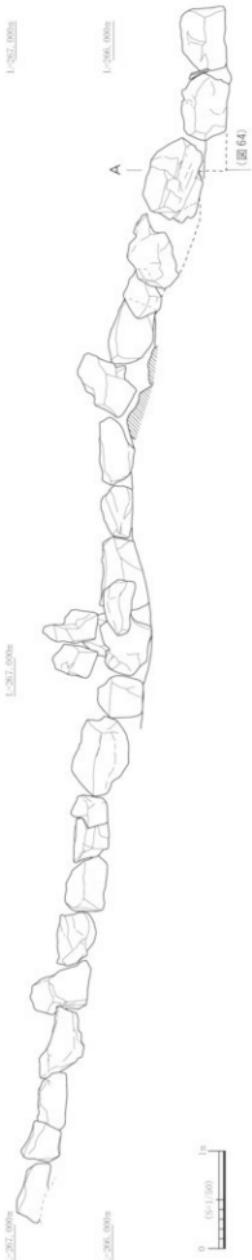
高石垣直面前崩落部で確認した根石立面図 (S=1/50)
